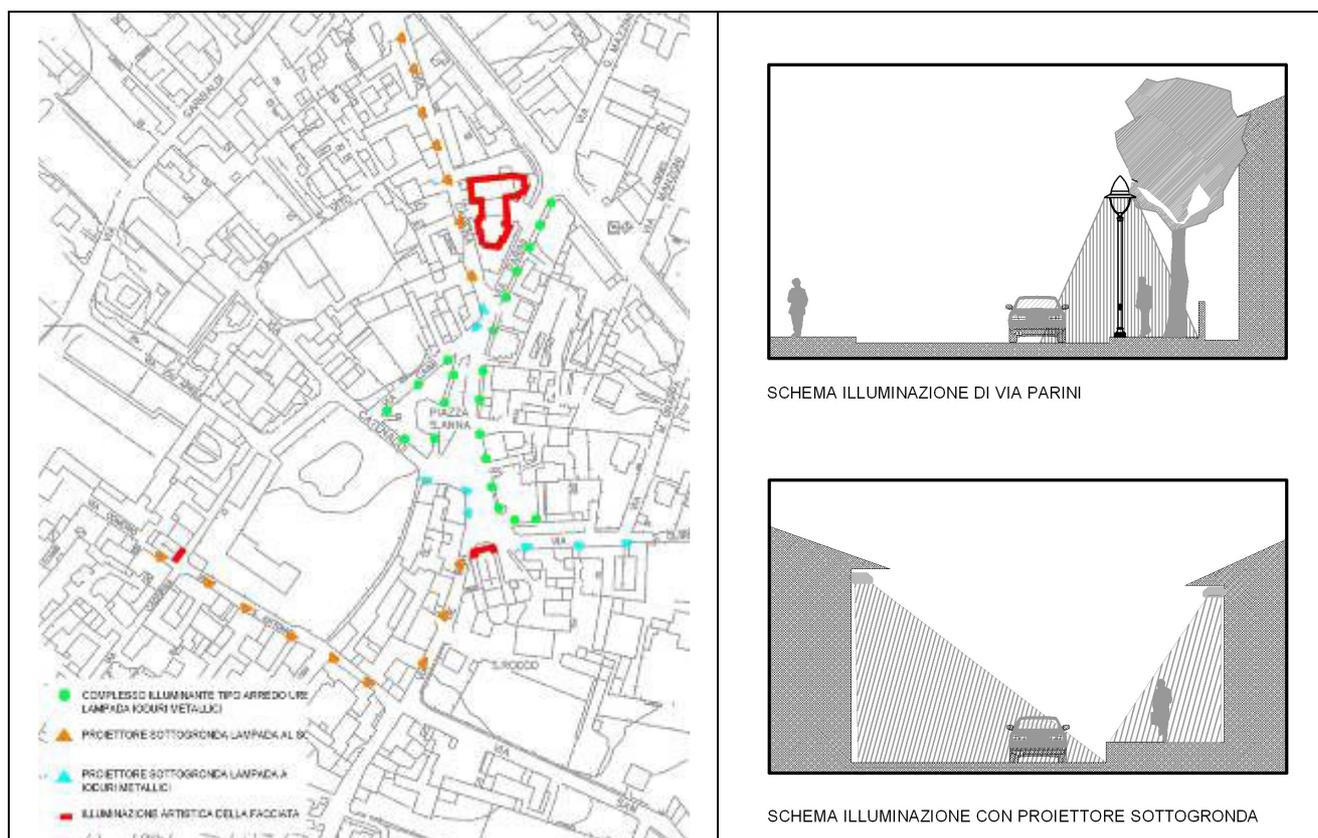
Tavola del progetto d'illuminazione del centro storico
